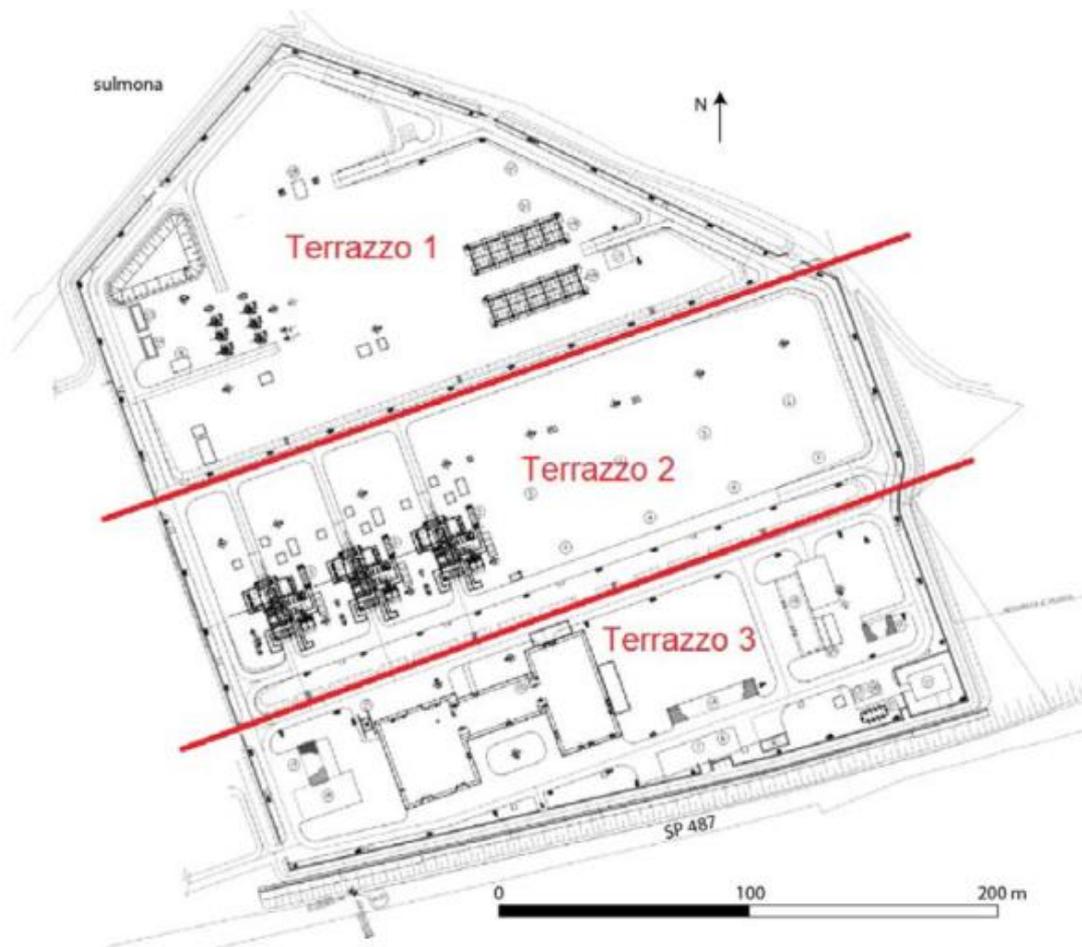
Layout Impianto di Compressione gas con indicazione delle aree terrazzo
